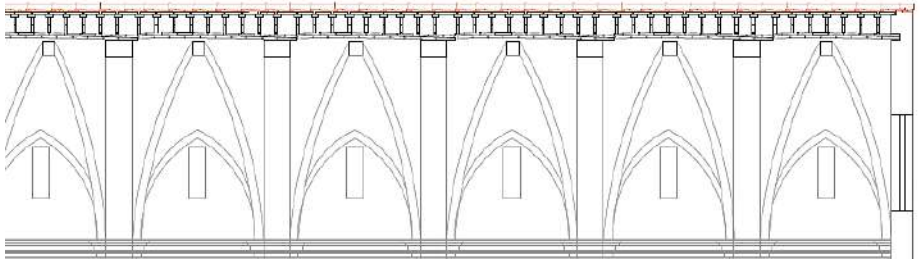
Detalle de la cubierta en sección. Imagen propia 20/08/17
